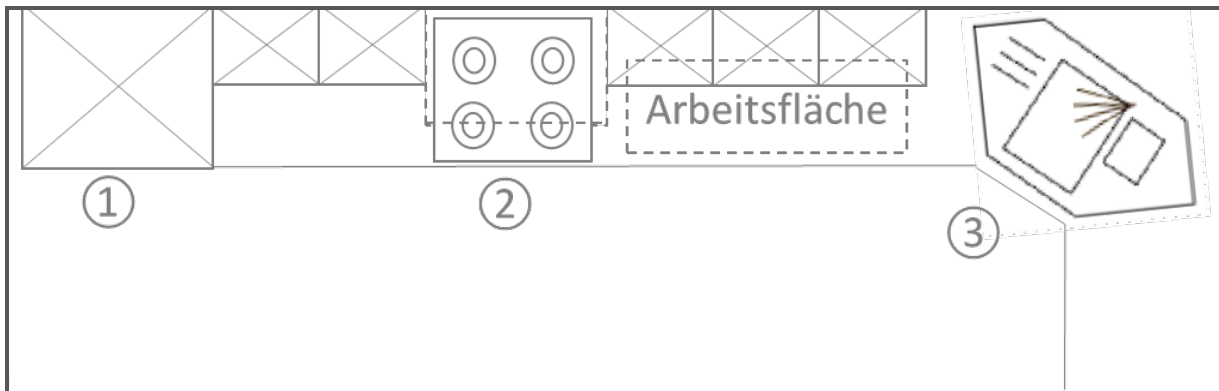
Grundriss der Versuchsküche; 1) Kühlschrank, 2) Herd mit Dunstabzugshaube, 3) Spülbecken
